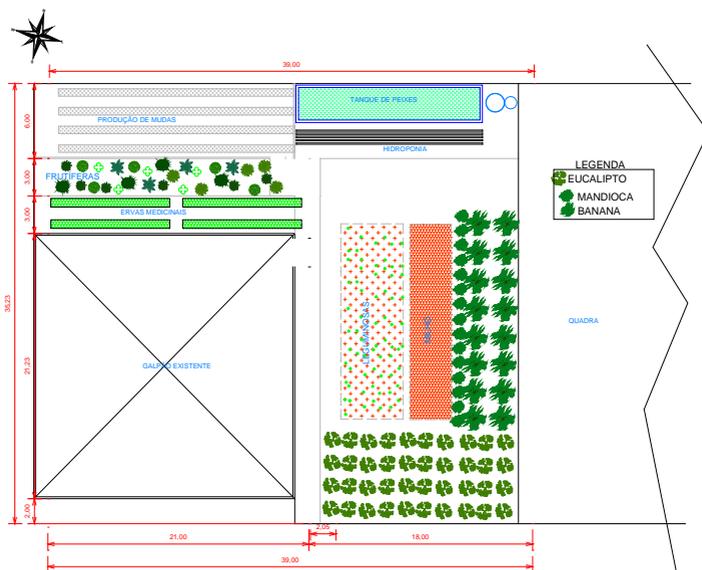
Planta do terreno com indicação das áreas de produção integrada.
